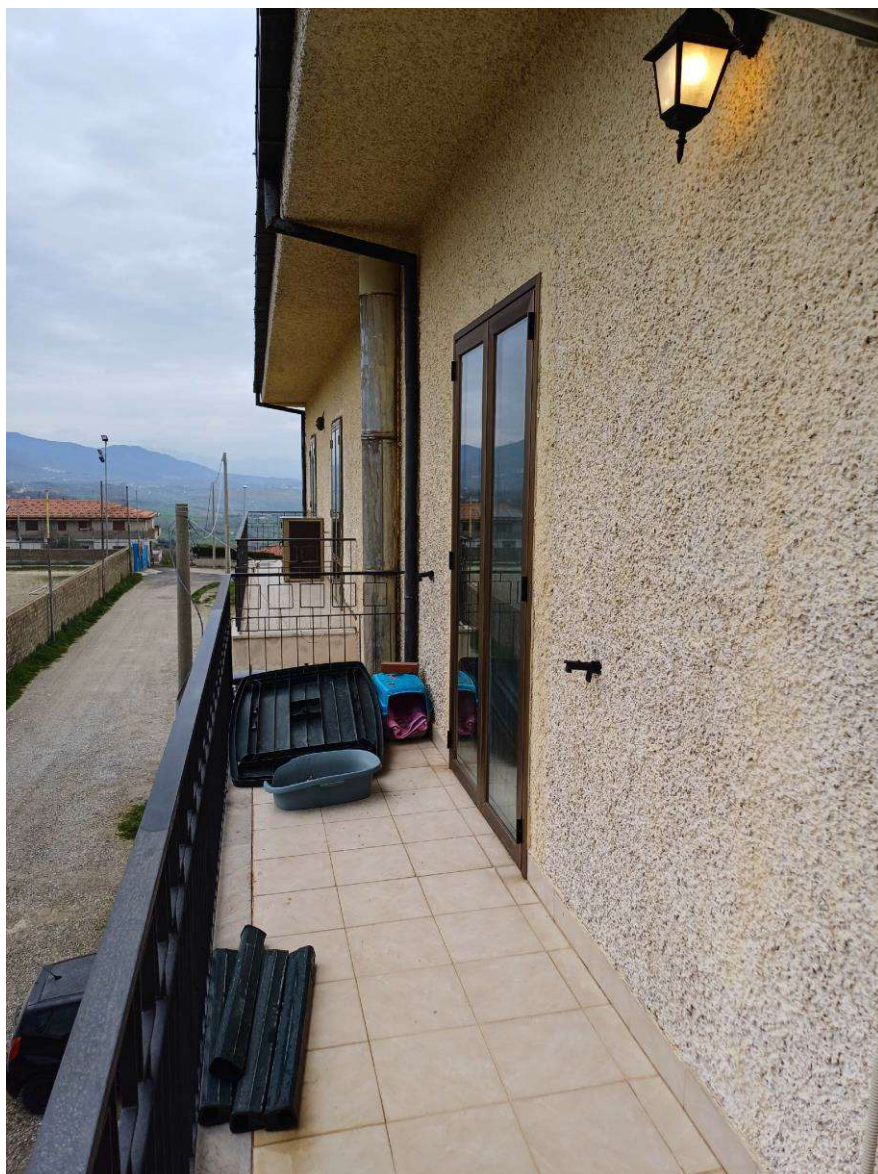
Balcone con accesso dal soggiorno e dalla camera 1
